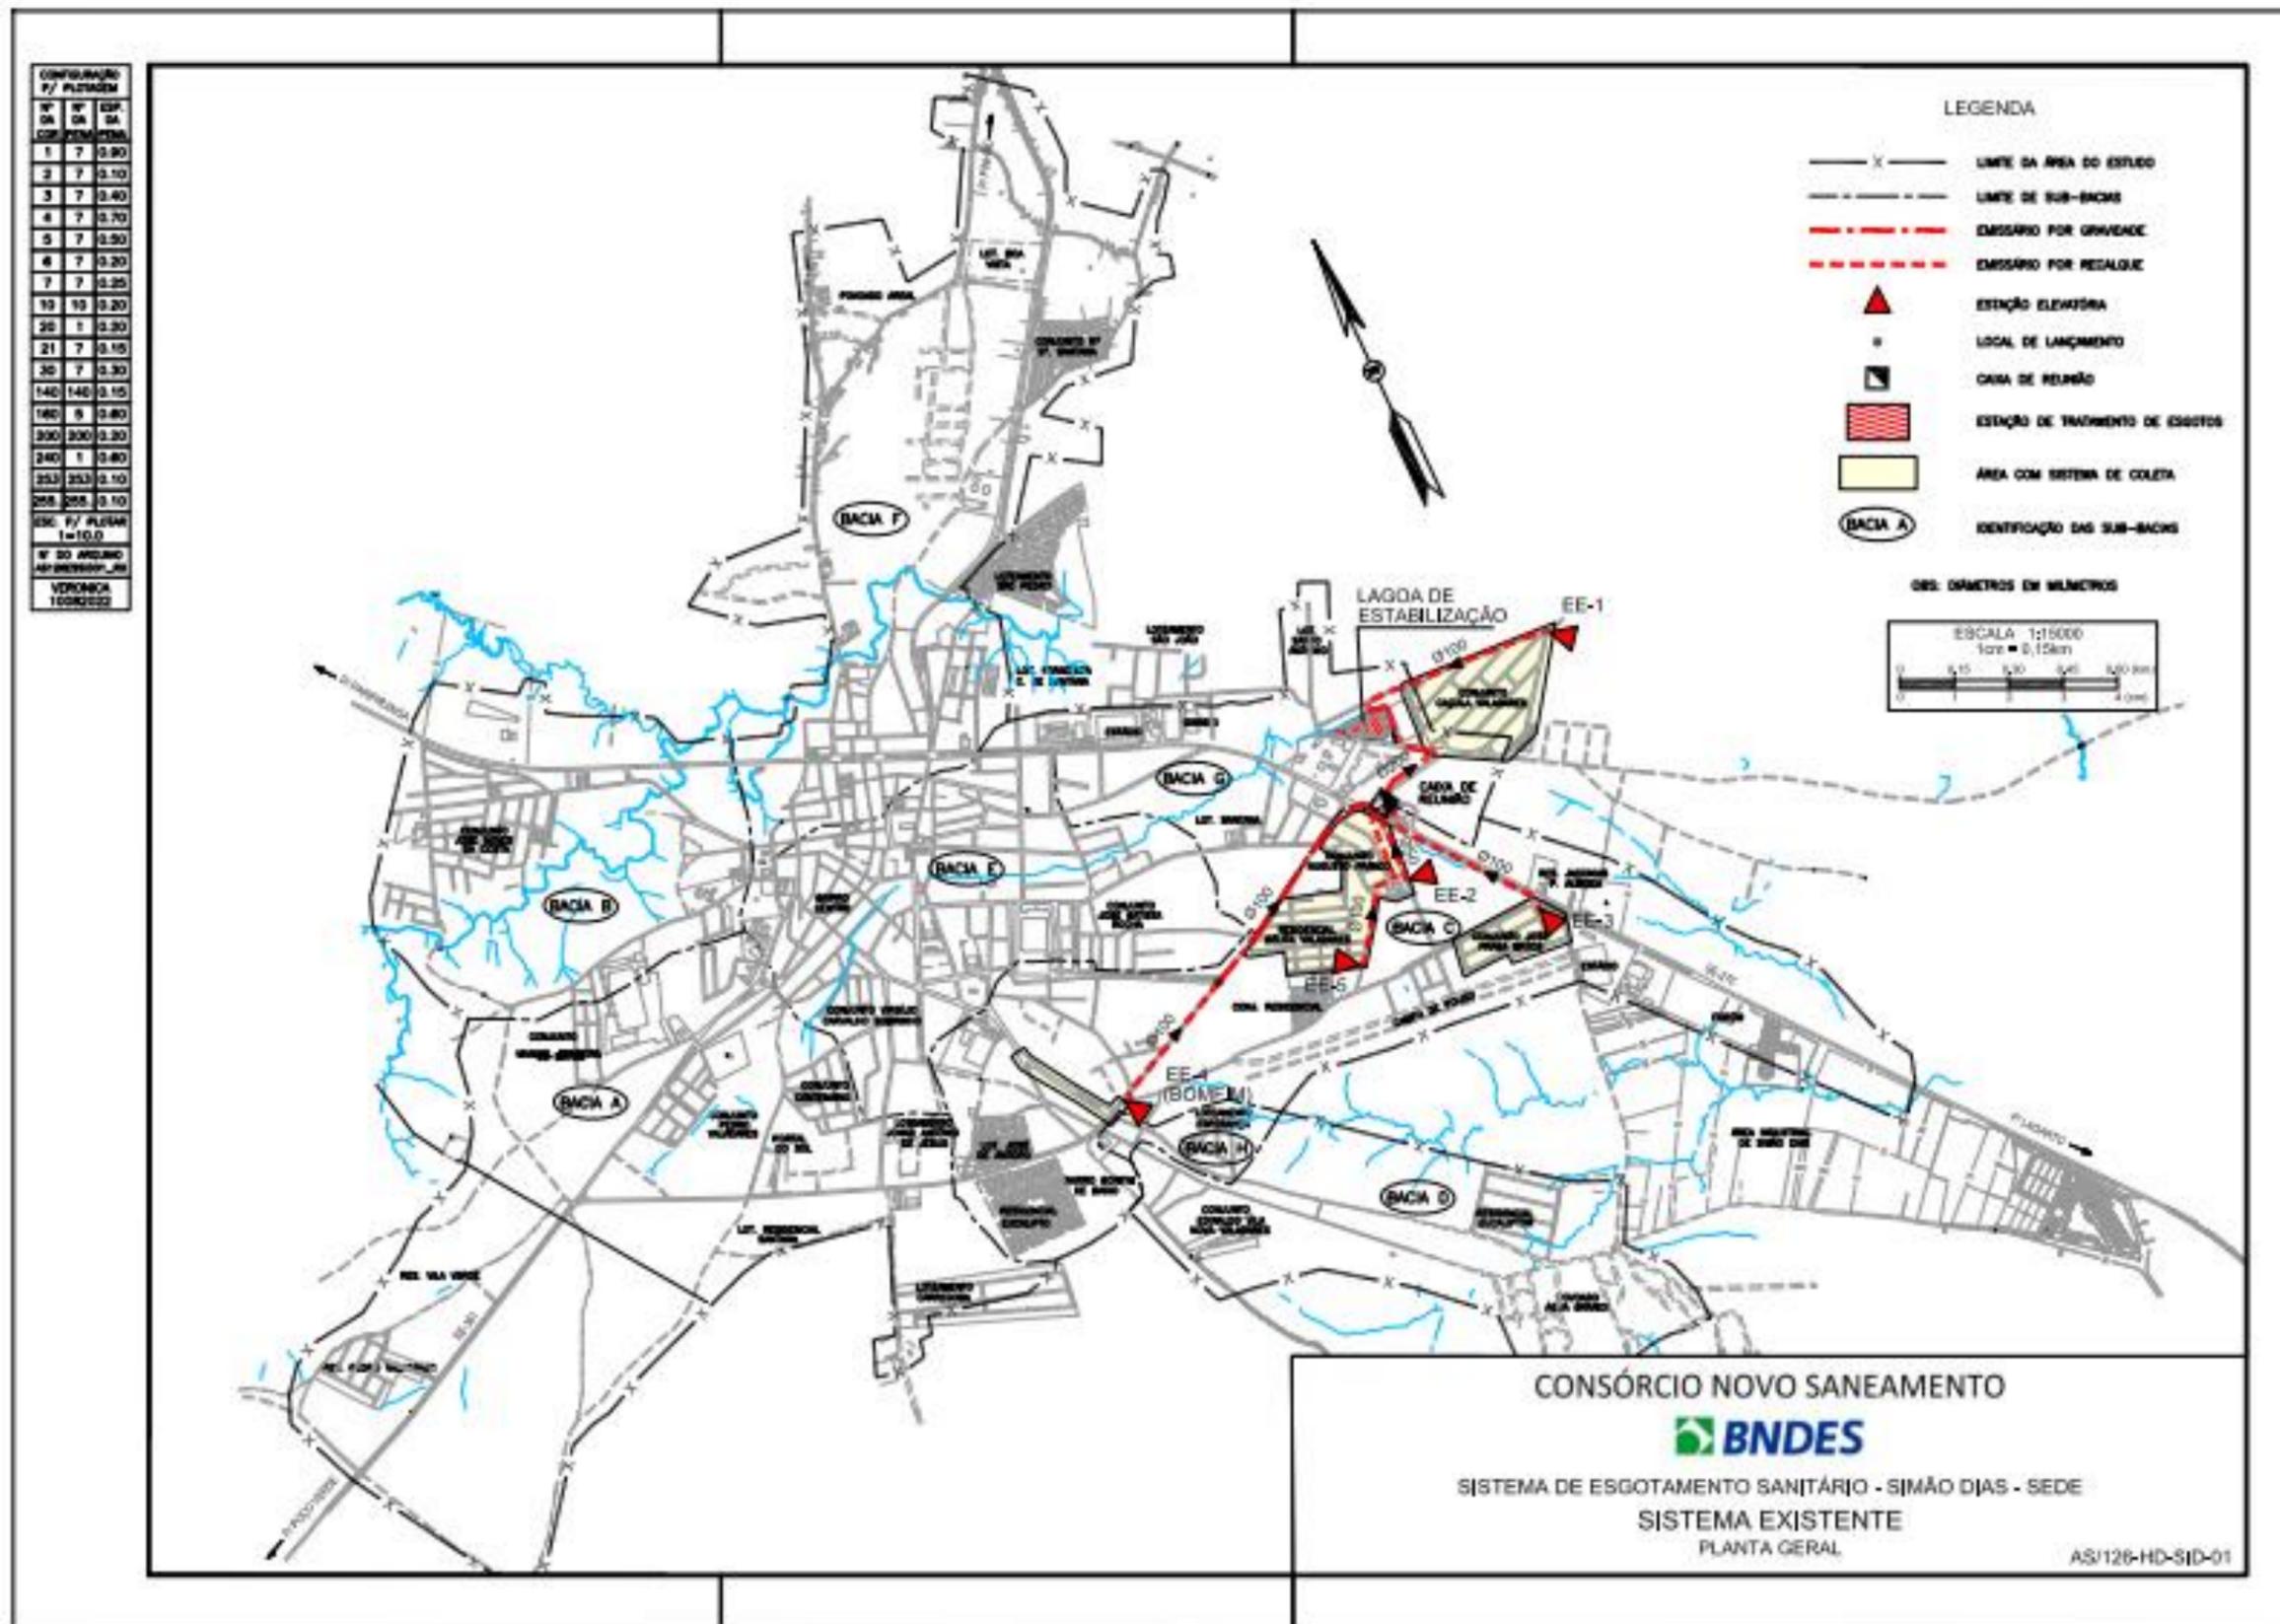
Planta do Sistema de Esgotamento Sanitário – SIMÃO DIAS
